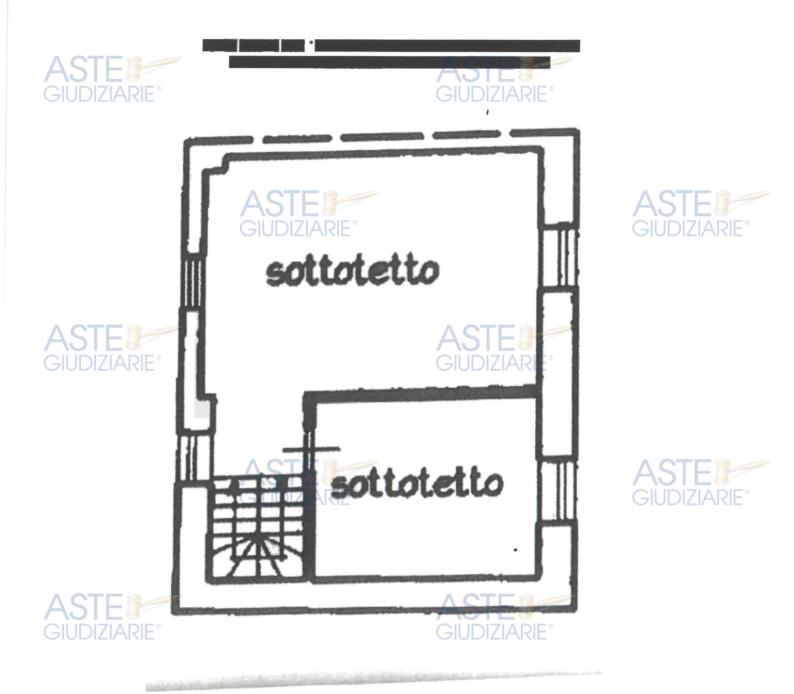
Pianta Piano sottotetto desunta dalla planimetria catastale, in quanto non accessibile al momento del sopralluogo
